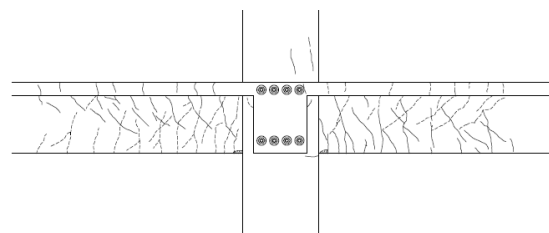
ひび割れ状況（HRPC21）部材角 1/50rad
